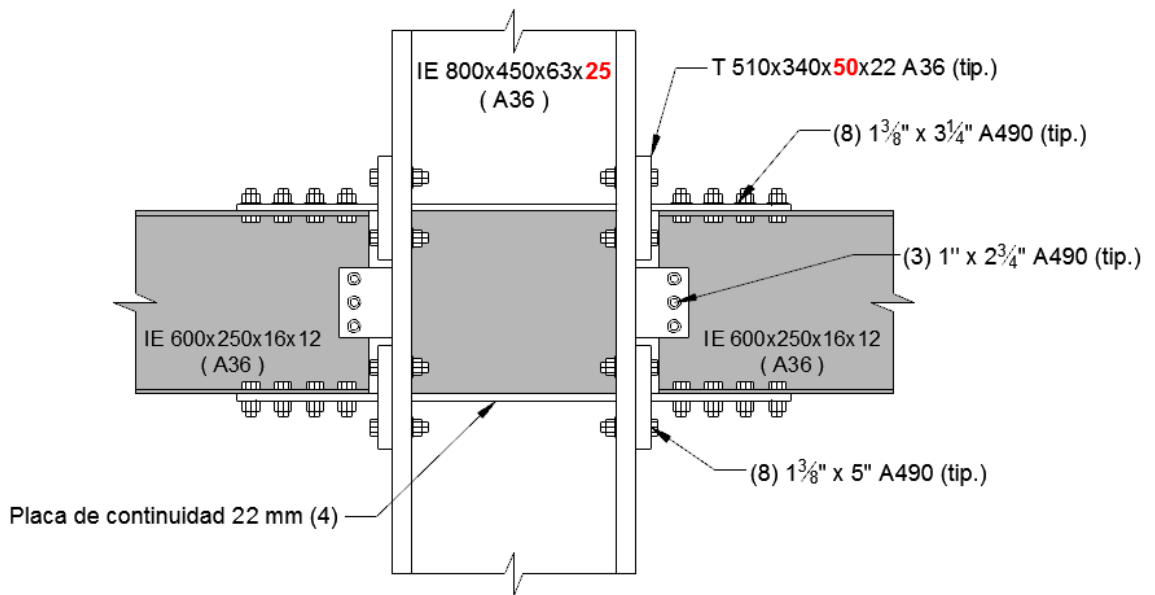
Detalle de conexión SE-04 (DBT1). Fuente: Salas (2016)
